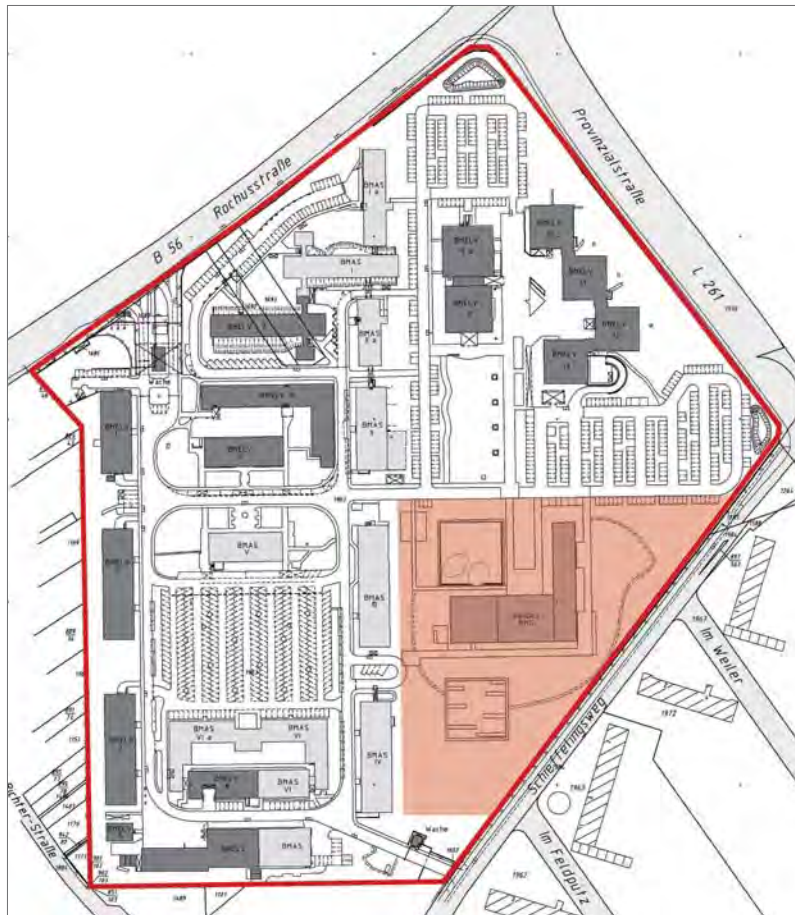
Lageplan - Baufeld des Bundesministeriums für Gesundheit auf der Liegenschaft Rochusstraße in Bonn
